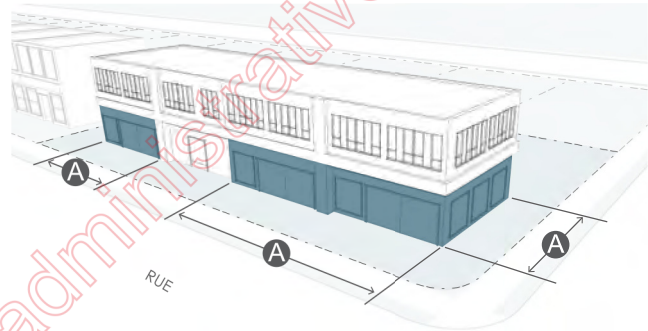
Mesure de la largeur d'une façade dans le cas d'un bâtiment comportant plusieurs locaux au rez-de-chaussée
